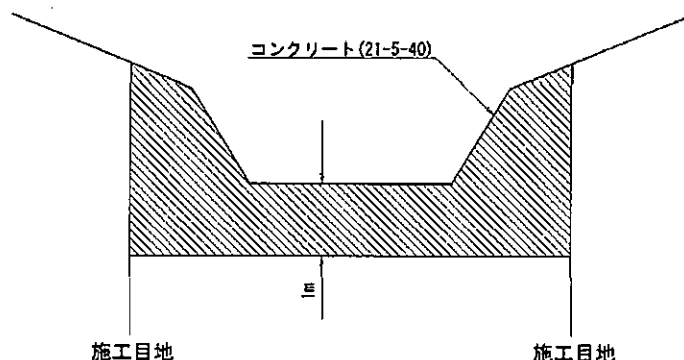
不透過型砂防堰堤の堤冠保護工施工範囲
